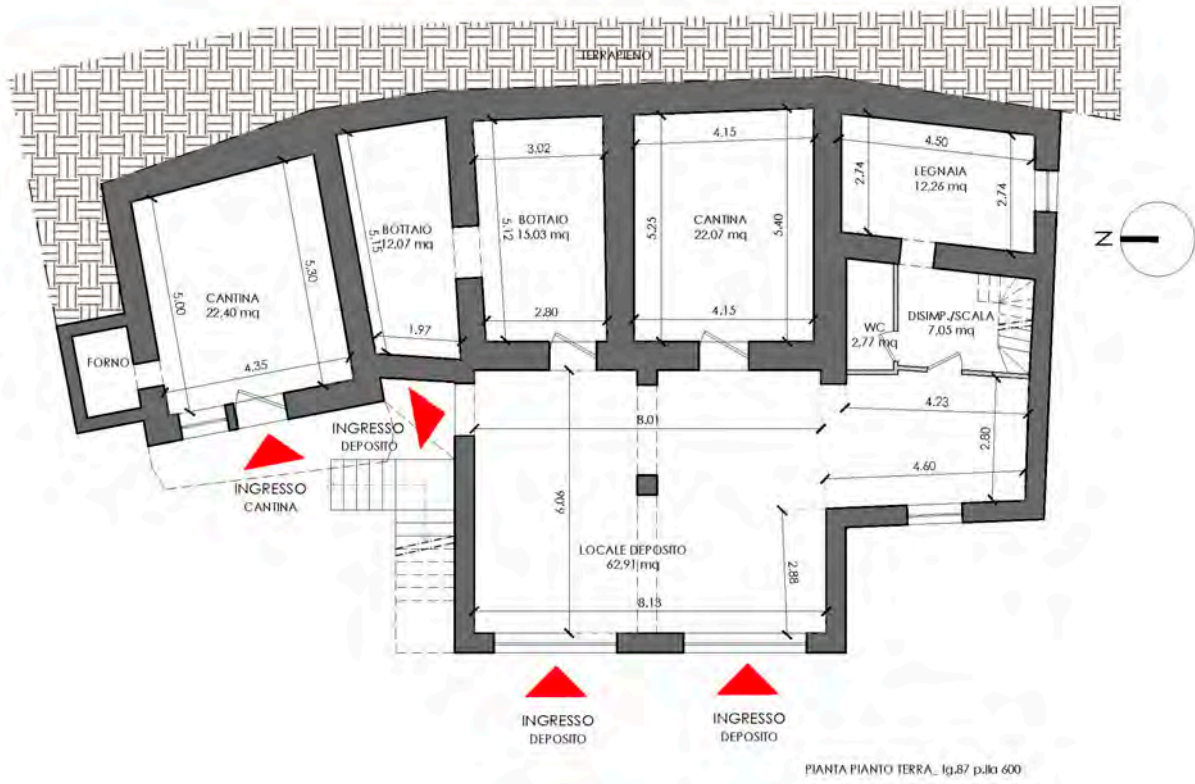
Rilievo Abitazione Lotto Uno Stato di fatto \_ pianta piano terra (Allegato 6D)
